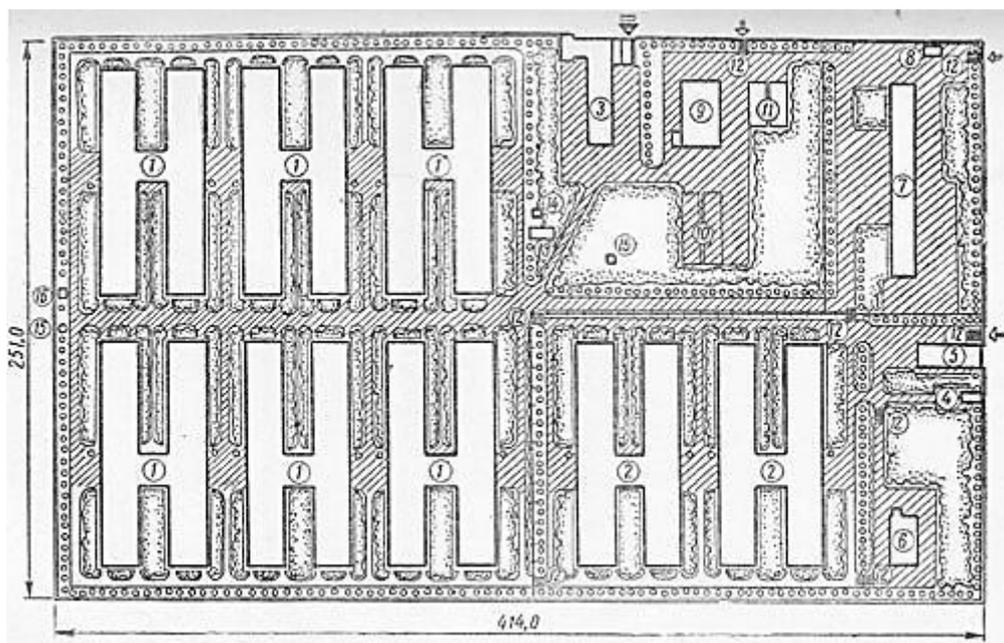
Схема генерального плана свиноводческой откормочной фермы на 24 тыс. голов:
